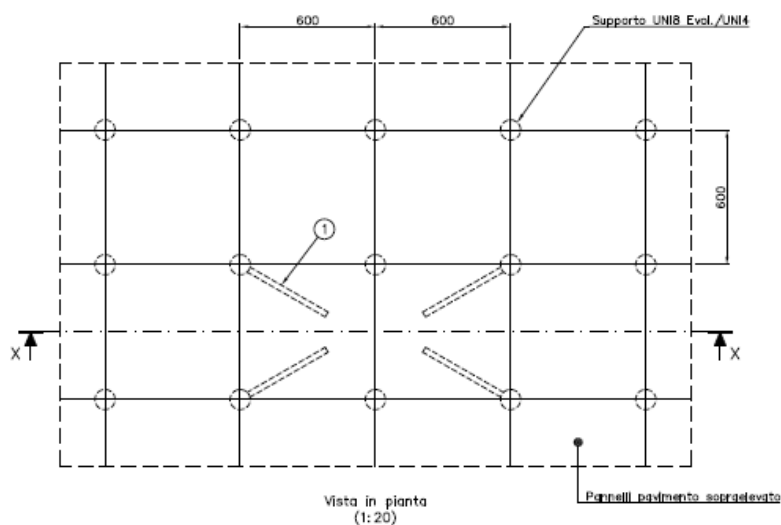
Vista em planta de um sistema de chão falso com contraventamentos [26]
